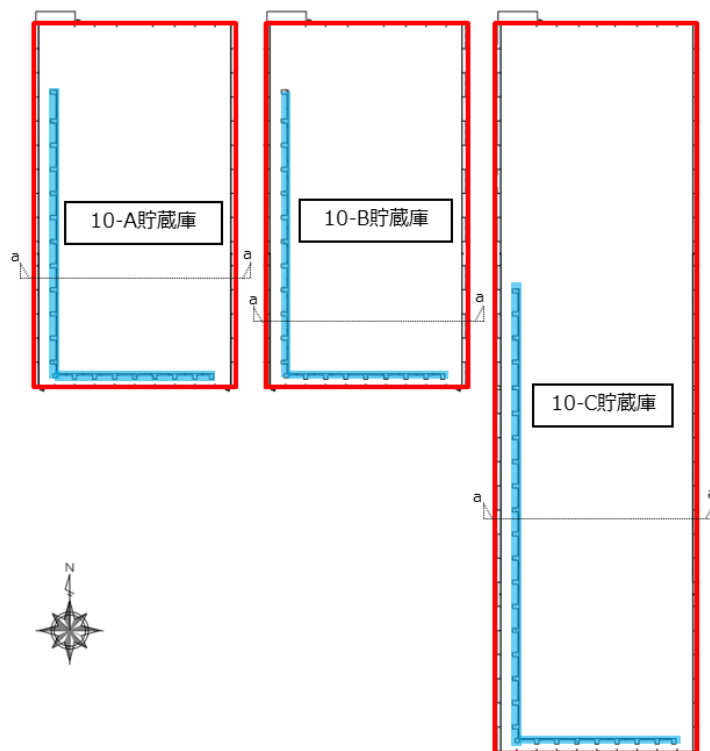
固体廃棄物貯蔵庫第10棟建屋配置図
